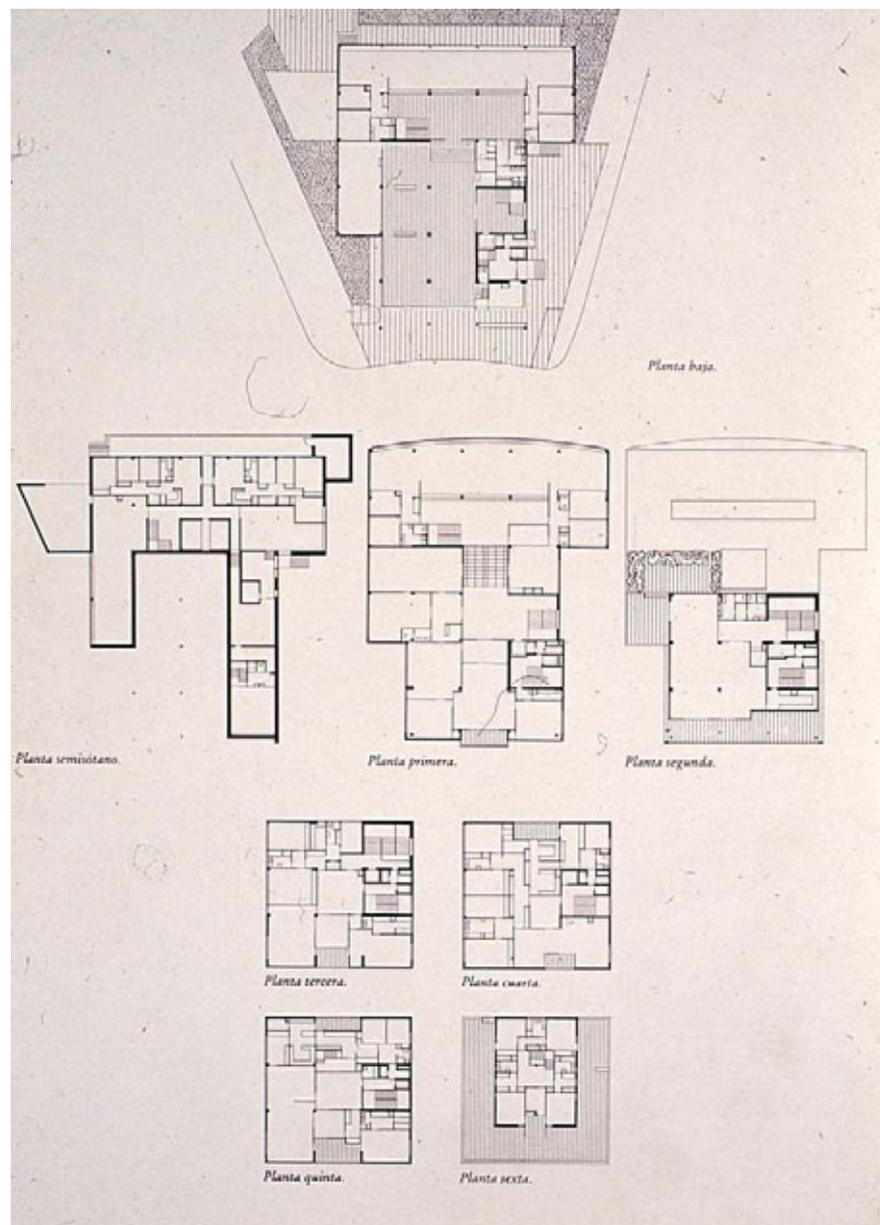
Planos de proyecto reformado. Fundación Alejandro de la Sota.
